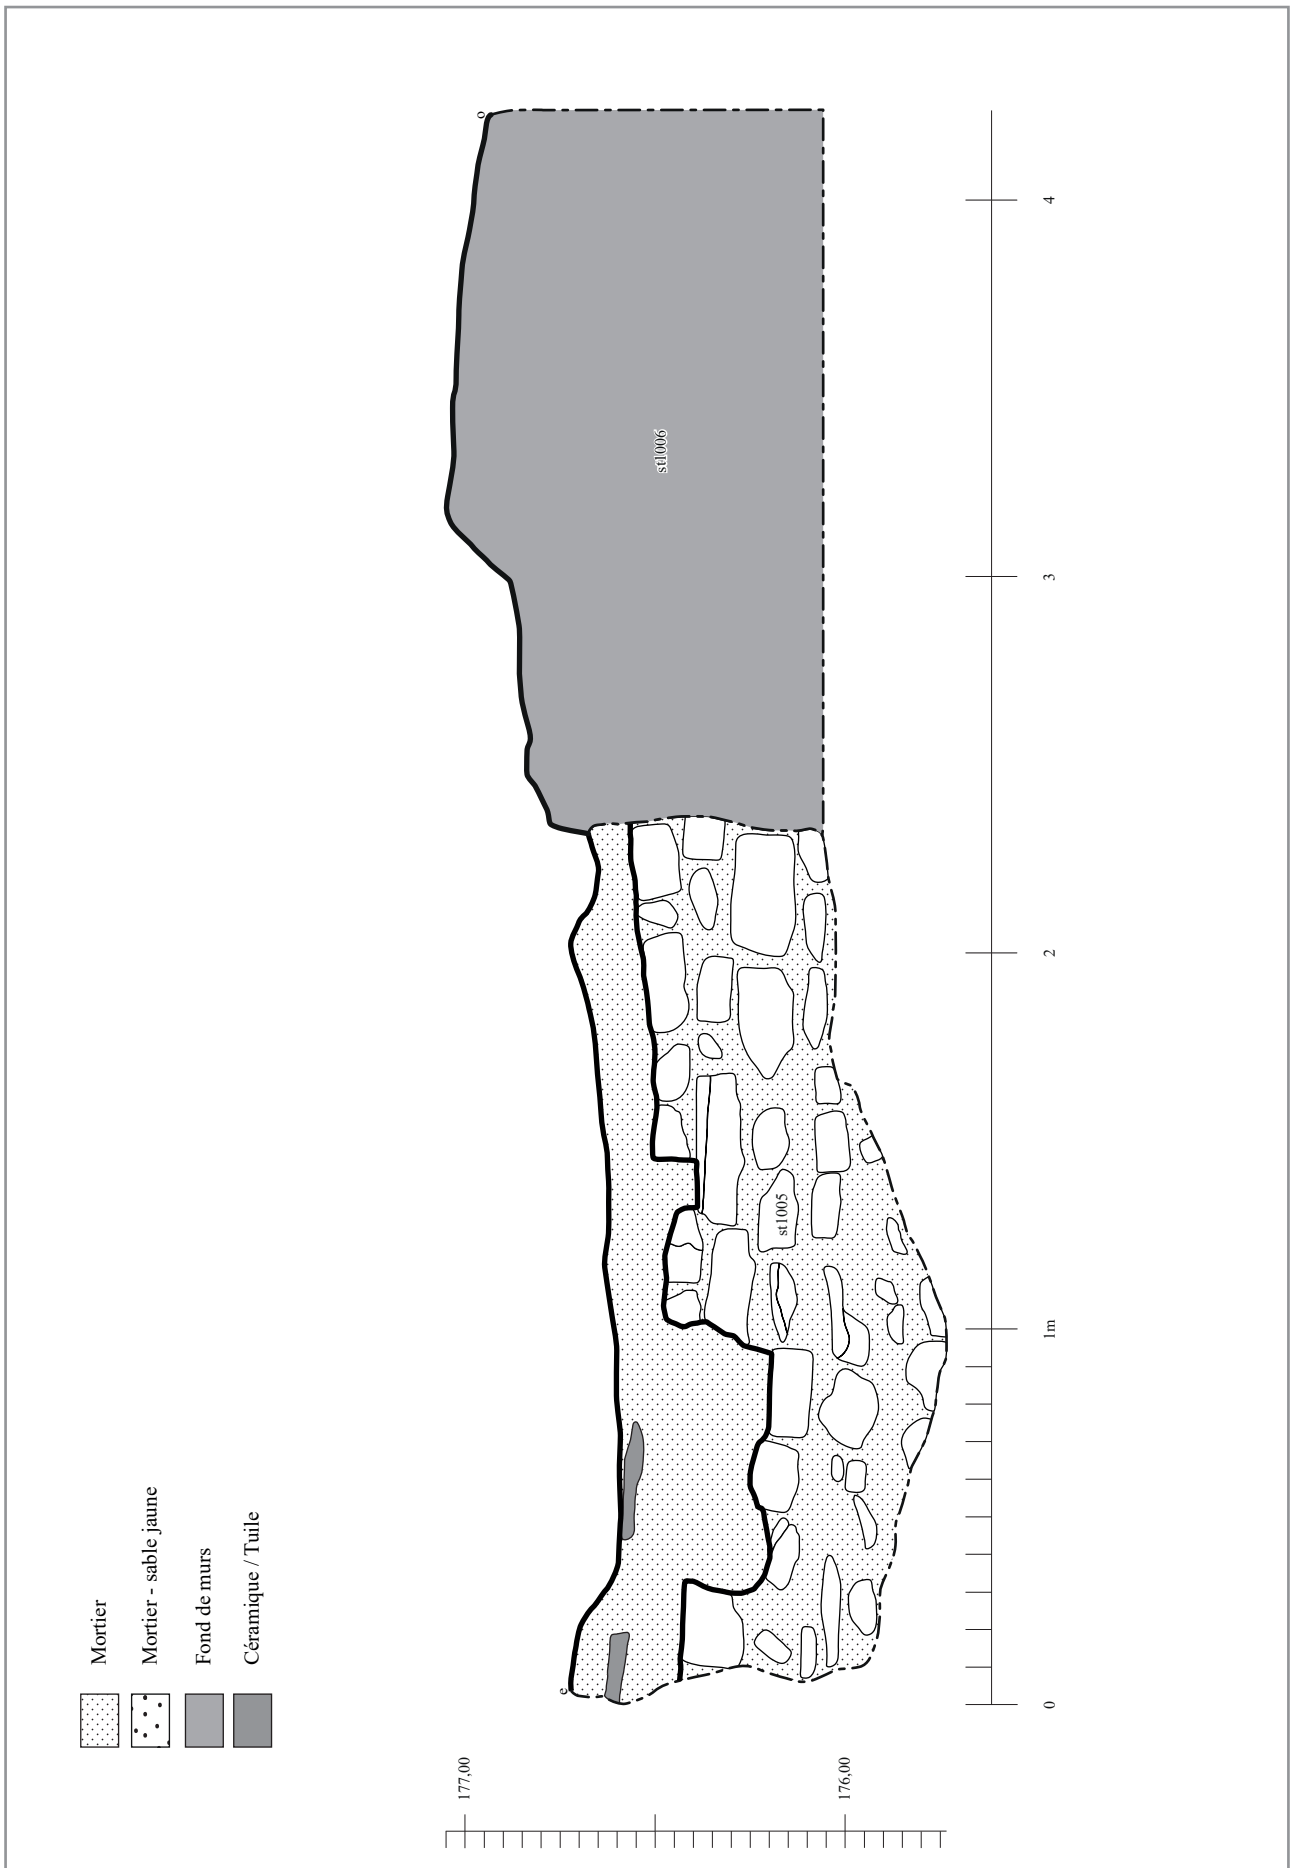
Parement nord mur 1005 (échelle : 1/20 ; DAO : N. Lenôtre).
